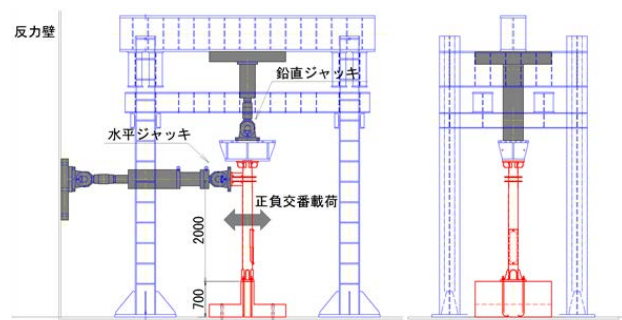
正負交番載荷試験装置の概要図 (単位: mm)
